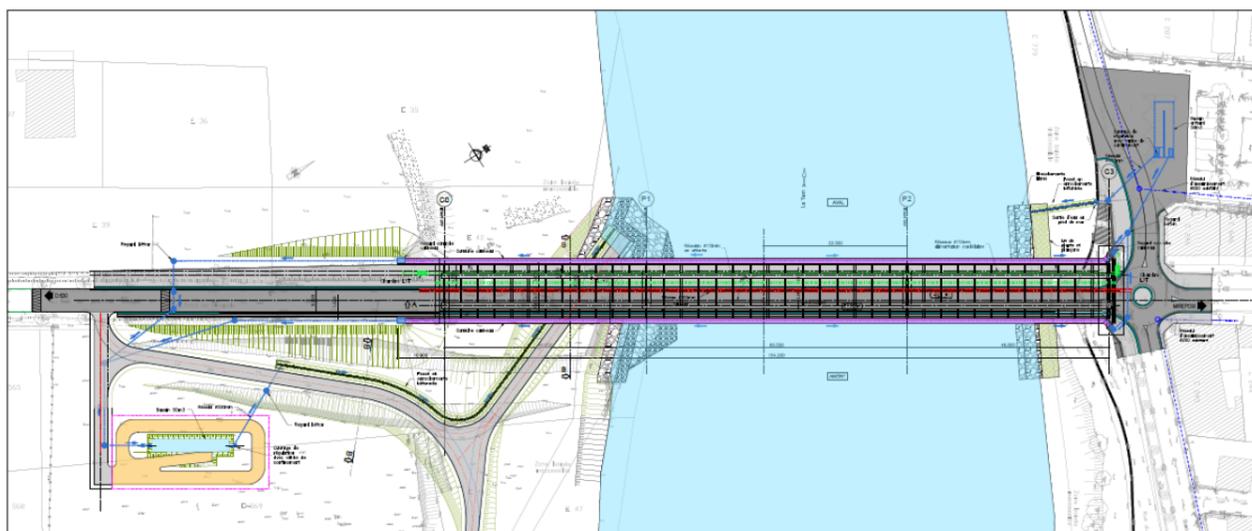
Vue en plan de l'assainissement – Extrait Plans AVP (Ingérop)
